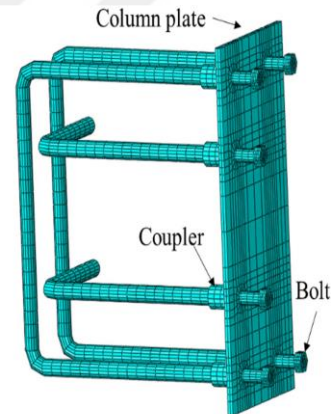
Kolon-kiriş bağlantı elemanı (Song ve ark., 2015)
